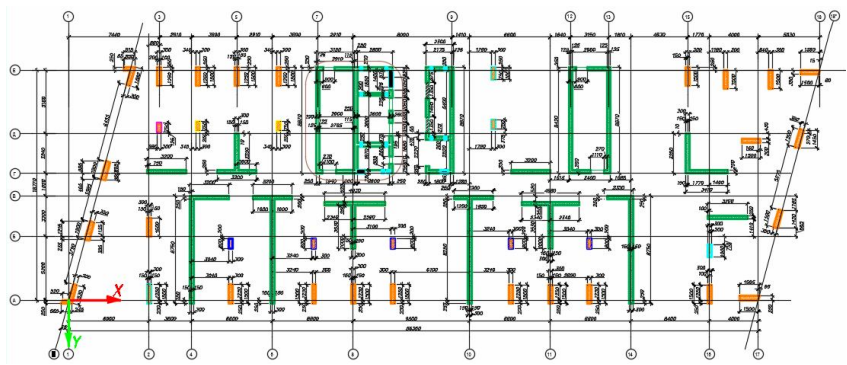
План розташування вертикальних несучих елементів каркаса 34-го поверху будівлі
